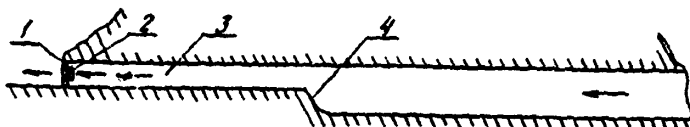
Сквозная вентиляция при раскрытии выработки на полный профиль:
